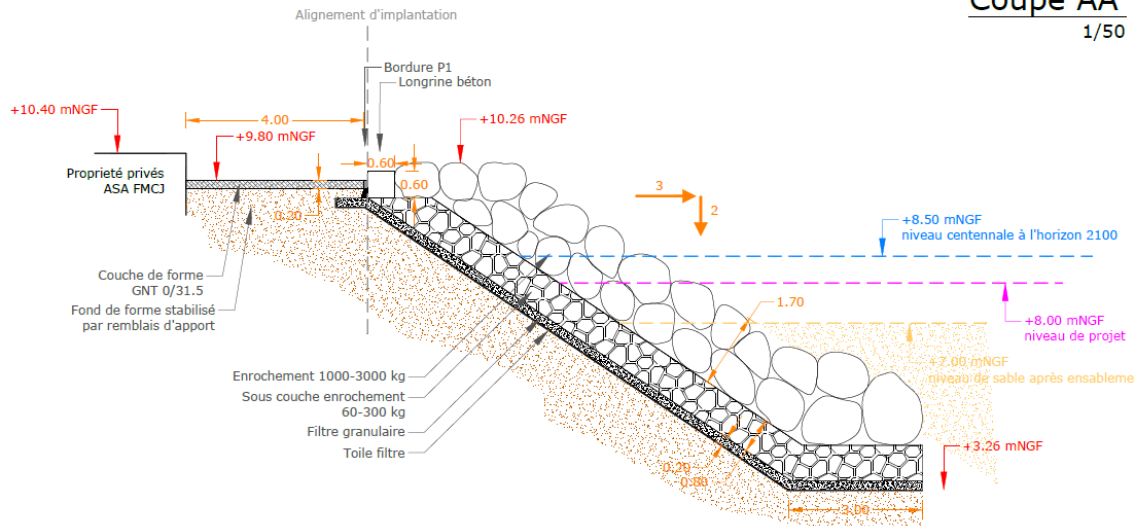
Coupe en travers de l'ouvrage - source : hydratec
